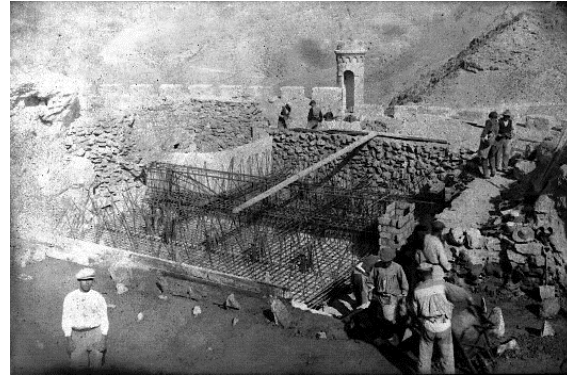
En la imagen se observa el mallazo, previo al vertido del hormigón, para el forjado de gran canto. (Fuente: Lorenzo, 2019)
